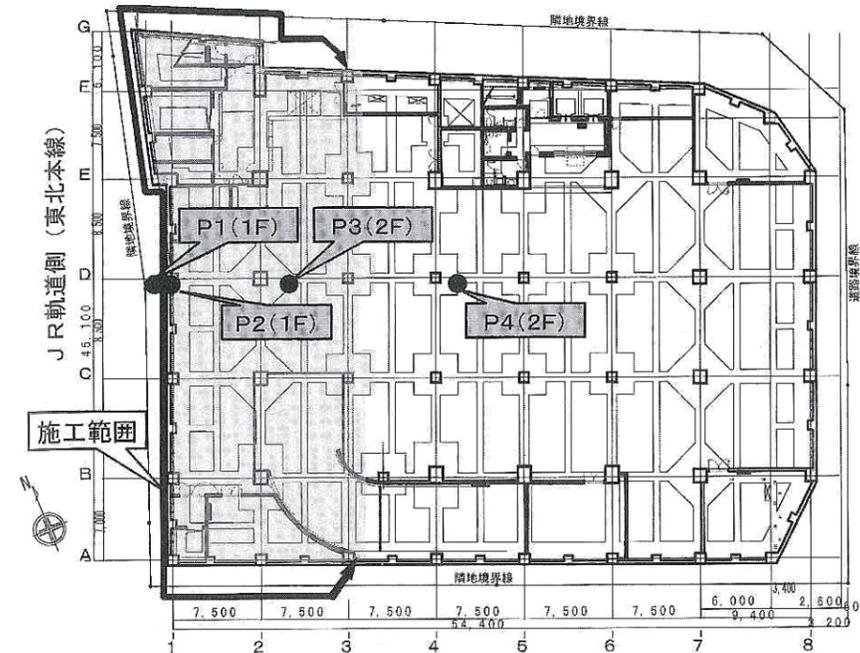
防振セパレータ施工範囲と測定点(地下1階(基礎)平面図)
